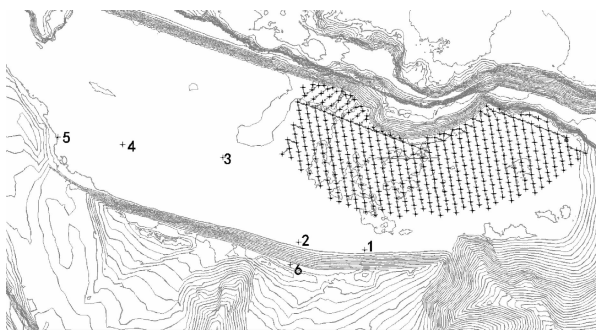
1364 ~ 1352 m 台阶爆破区域测振点布置示意图
